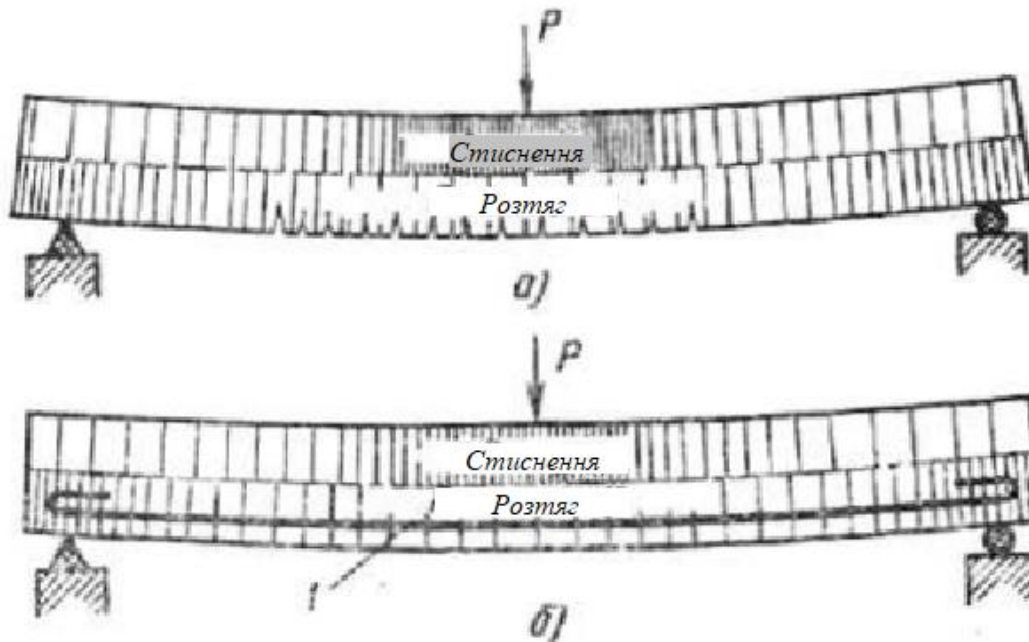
Неармована (а) і армована залізобетонна (б) балка.
